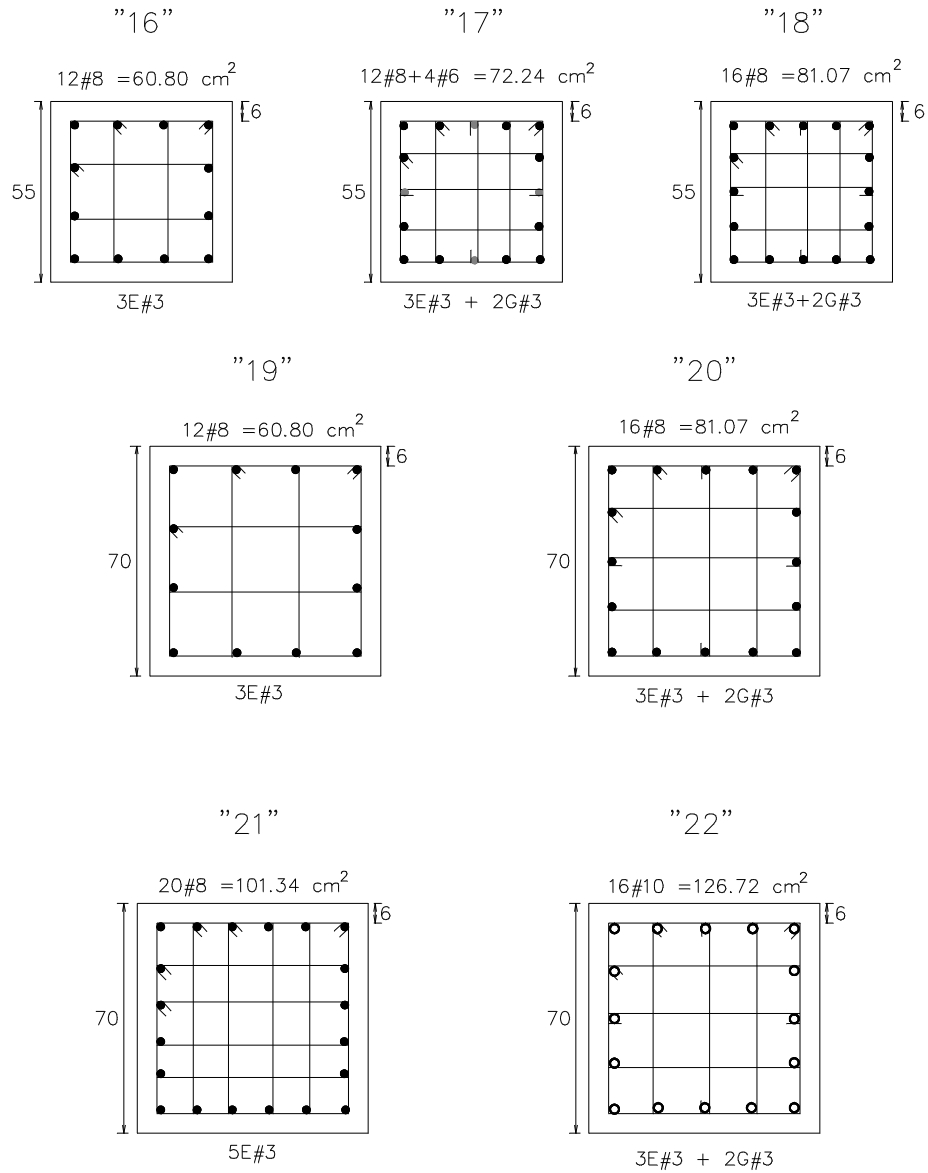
Tipos de armados propuestos para las columnas del eje 2, estructuras de 17 niveles diseñadas en zona III (RDF-93 y RDF-04)
